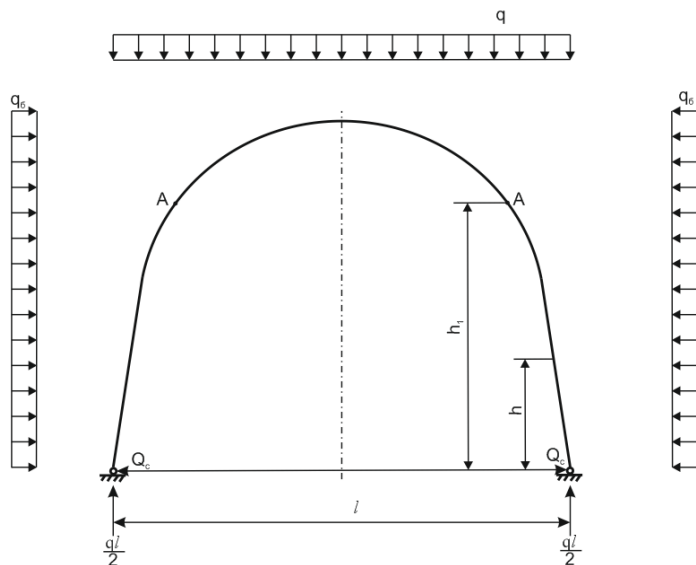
Расчетная схема к определению требуемой реакции опорной плиты
